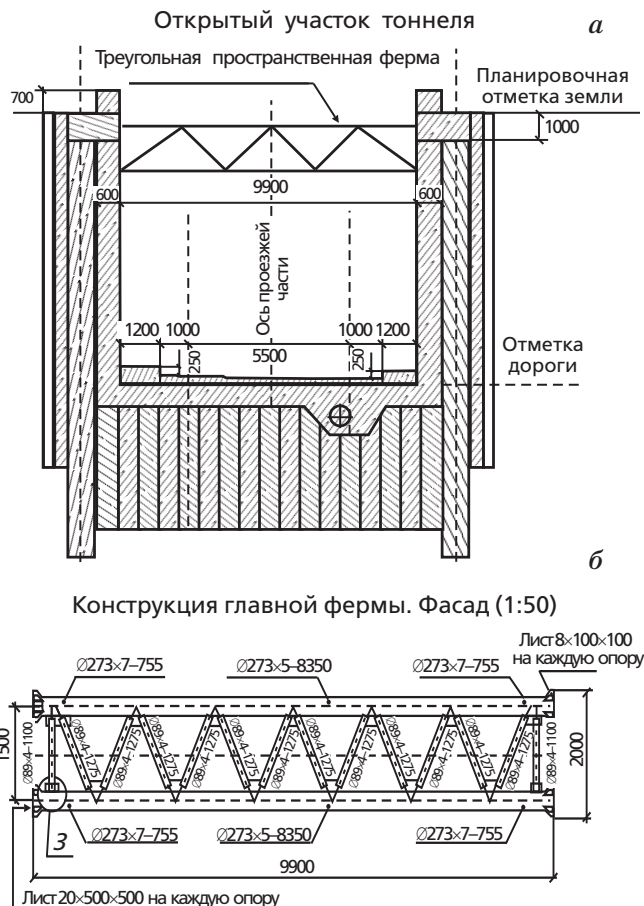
Форма и габаритные размеры монолитных железобетонных рамных конструкций открытых участков тоннеля, включающих металлические распорки, (а) и конструкция главной фермы (б)
